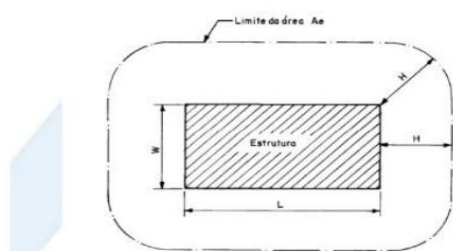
Delimitação da área de exposição equivalente (A_e) - Estrutura vista de planta
